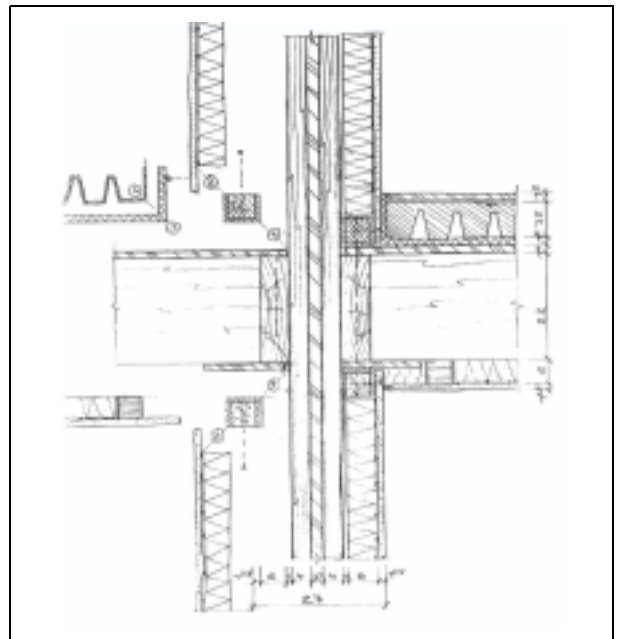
Mischkonstruktion einschalige Pfostenwand - Ausbau
